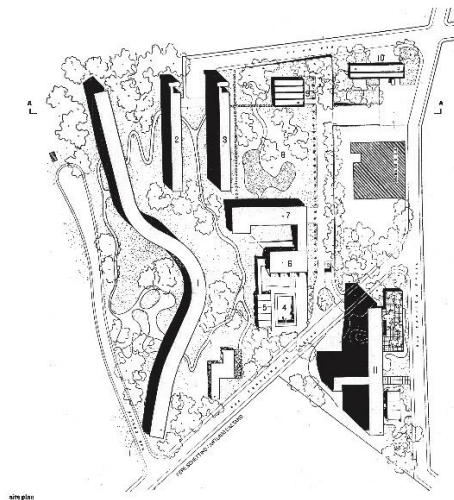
Conjunto Pedregulho: Implantação Geral. Fonte: The Architectural Review
